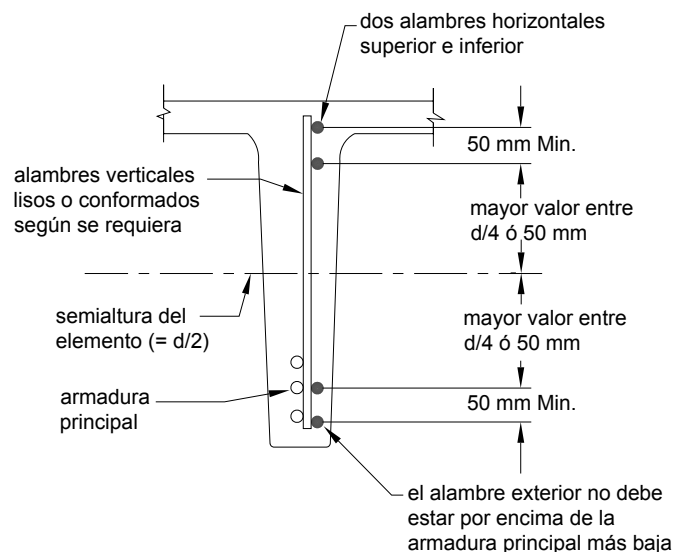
Anclaje de armadura de corte en forma de malla de alambre soldada de una rama, ACI (1989)
